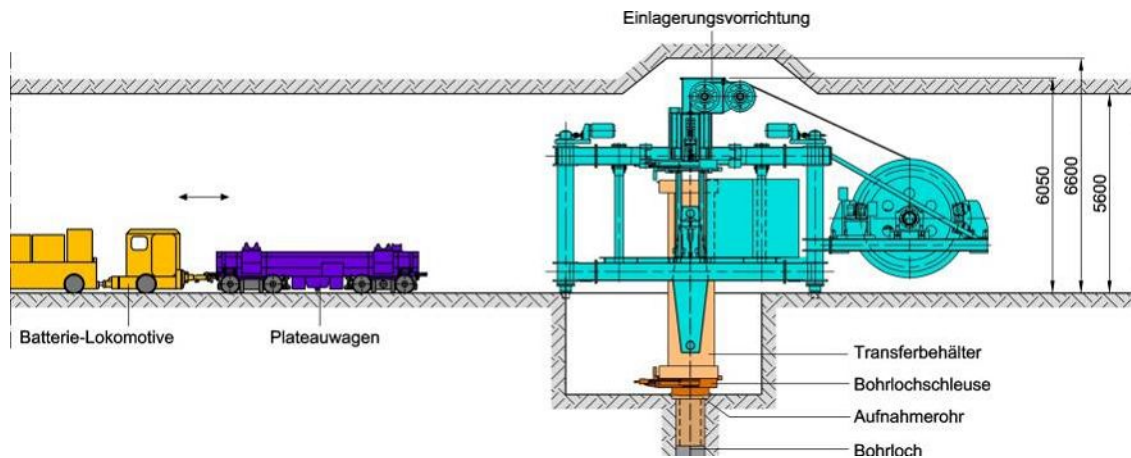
Systemzeichnung der Einlagerungstechnik für die Bohrlochlagerung von HAW- und Brennstabkokillen
